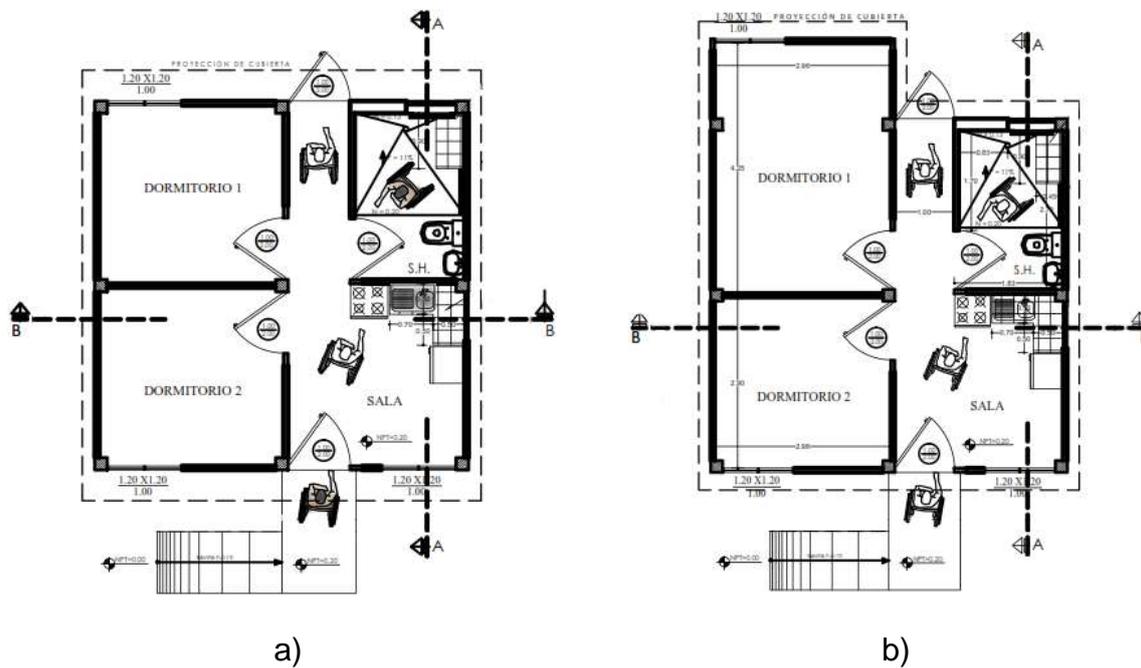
Plantas de las viviendas de: a) 36 m² y b) 40.34 m².
